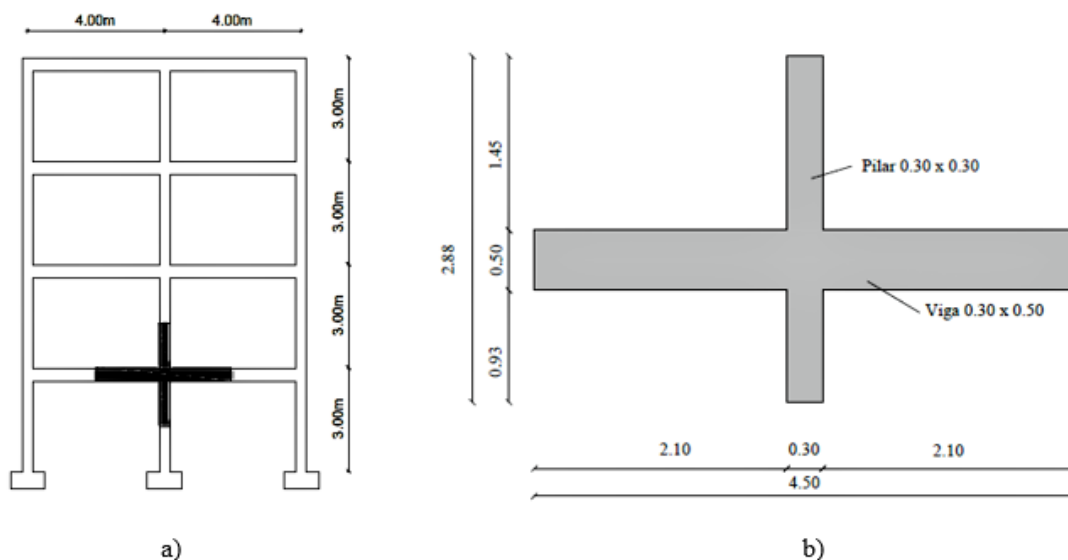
Nó viga-pilar em estudo: a) localização no pórtico do nós viga-pilar; b) dimensões do nó; adaptado de Garcia (2011)
